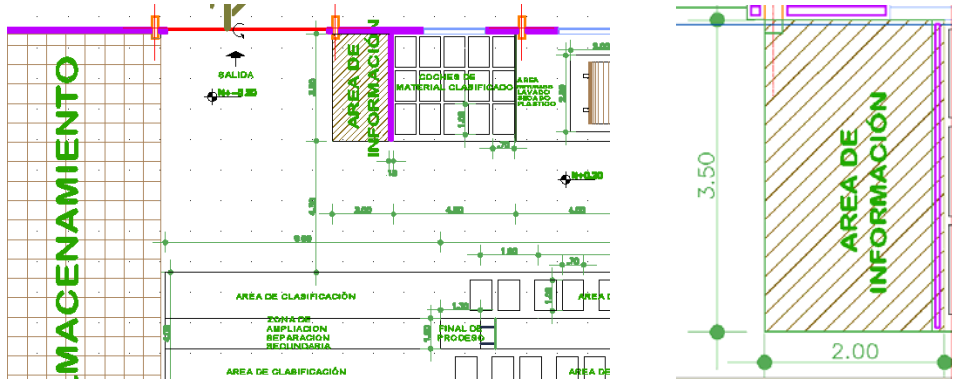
Vista arquitectónica general del área de información la planta de reciclaje
